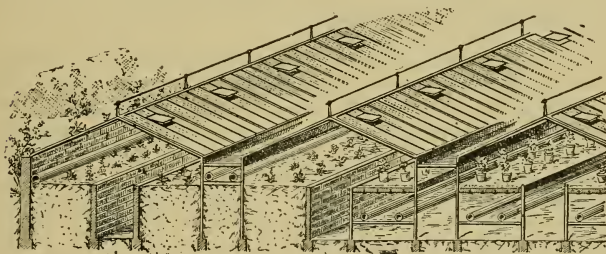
Assemblage de serres à deux versants. (Coupe transversale et vue perspective).
